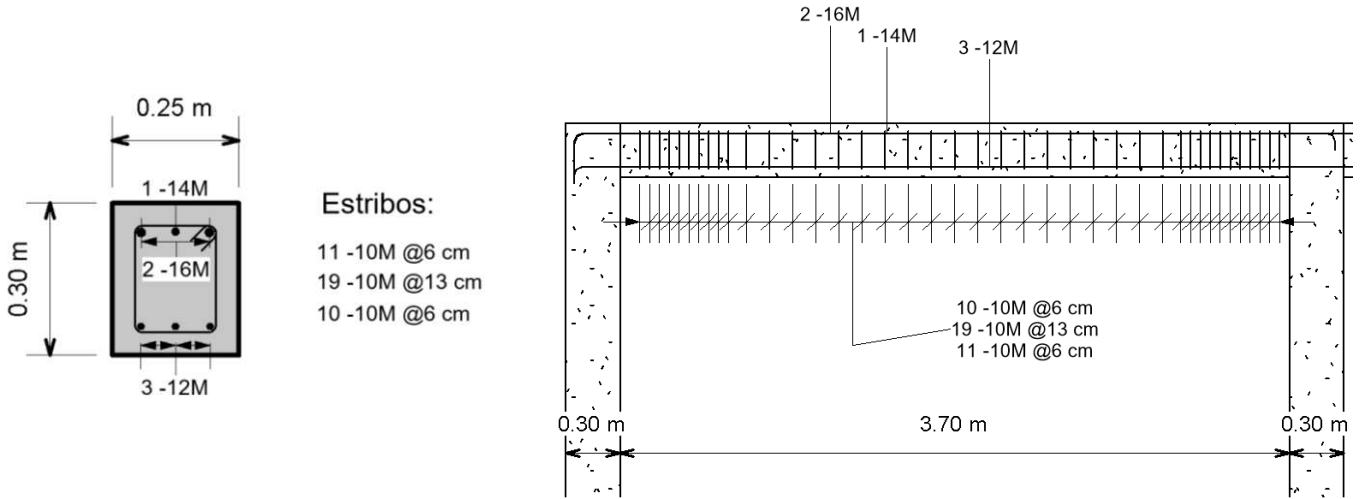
Dimensiones de la sección transversal y del refuerzo colocado en la viga 1 OMF del sistema de 6 pisos
